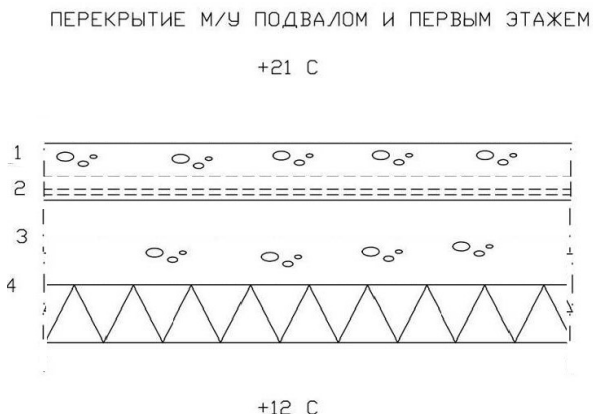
Разрез перекрытия между подвалом и первым этажом
